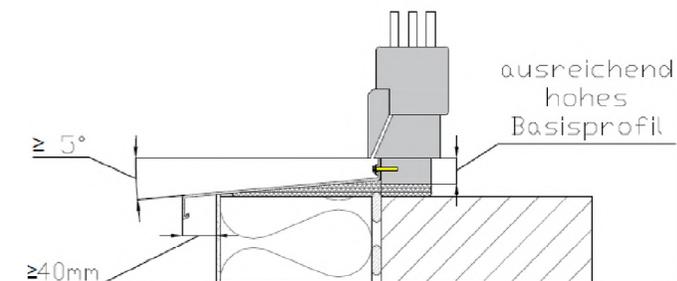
Rappresentazione schematica della proiezione del davanzale in lamiera rispetto al filo facciata. Fonte: A.A.V.V., 2020, *Richtlinie Fensterbank für deren Einbau in WDVS- und Putzfassaden in vorgehängten Fassaden sowie für Innenfensterbänke*, scaricato da www.dataholz.eu, pg. 15
